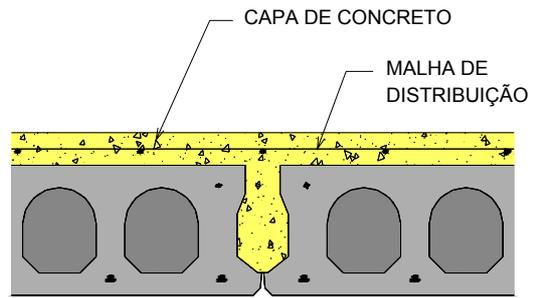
Painéis solidarizados com capa de concreto e malha de distribuição
